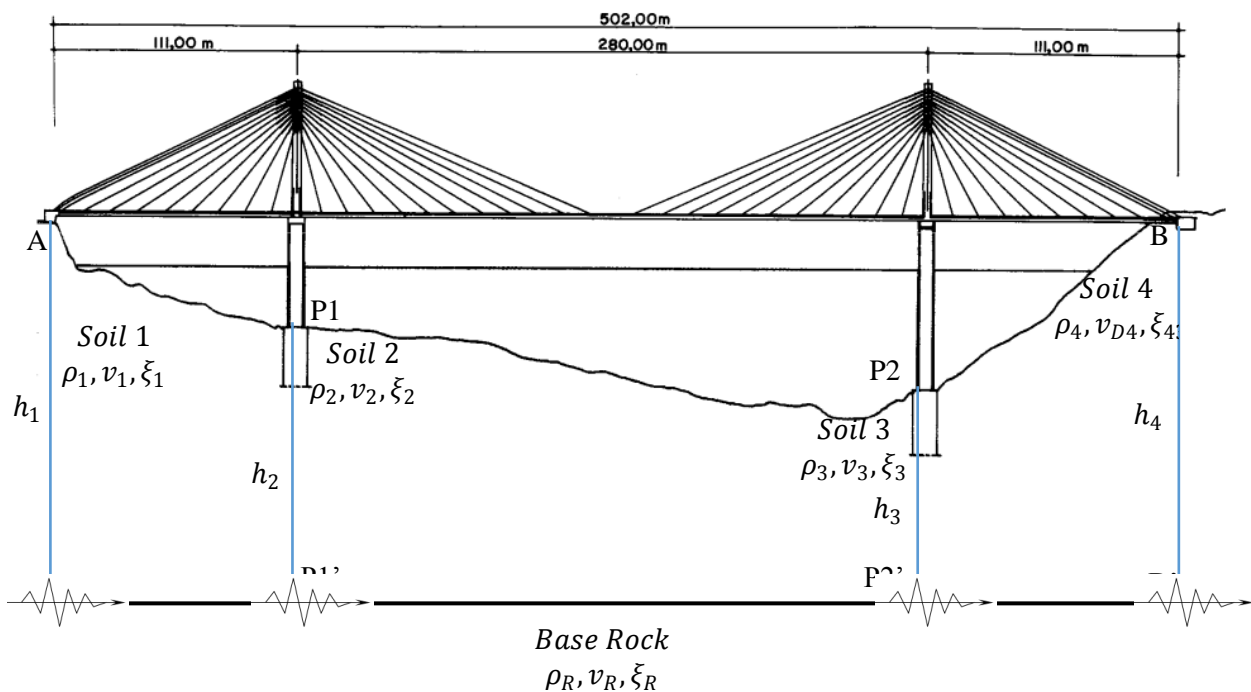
Vue longitudinale du pont et du sol de fondation.
